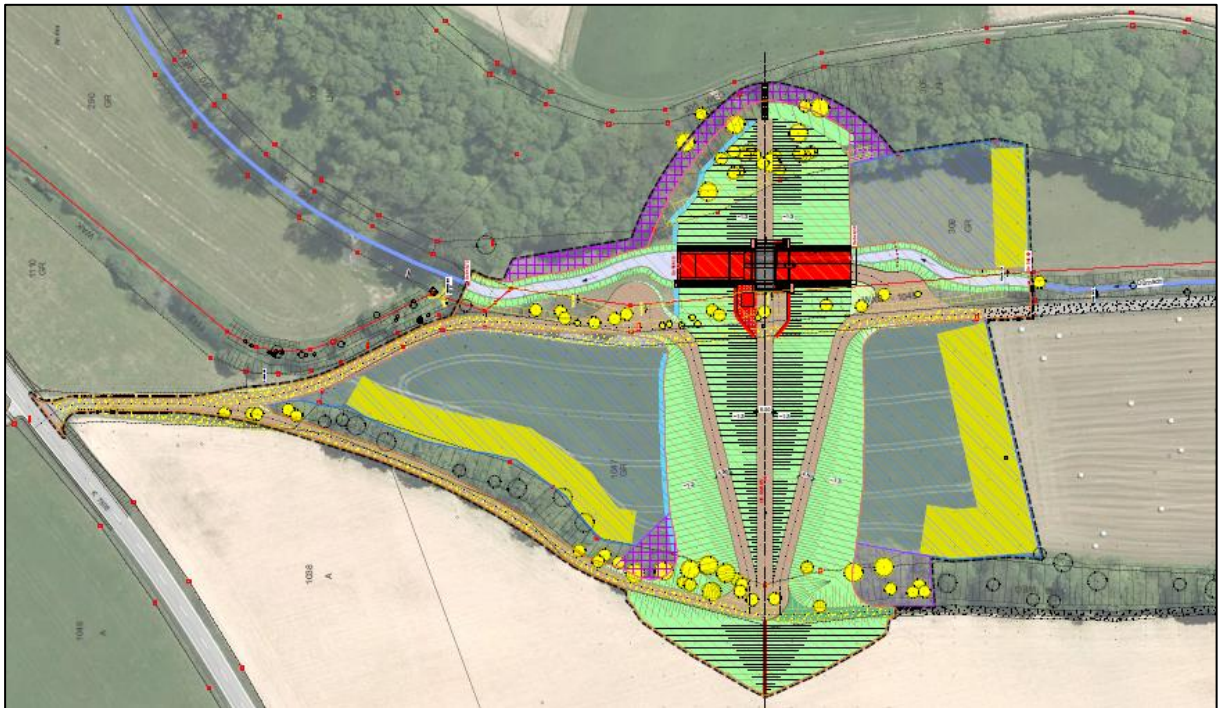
Lageplan Dammbauwerk HRB „Mittlere Halde“, Quelle RSI, 2024
